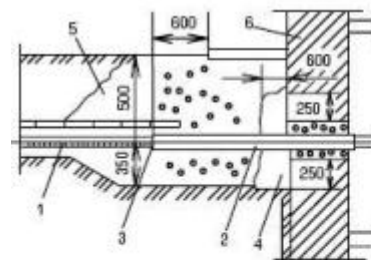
Підземний ввід кабелю через трубу в земле или кабельном сооружении: 1 — кабель; 2 — труба; 3 — уплотнение; 4 — гидроизоляция; 5 — песок без примесей глины и камней; 6 — стена здания
